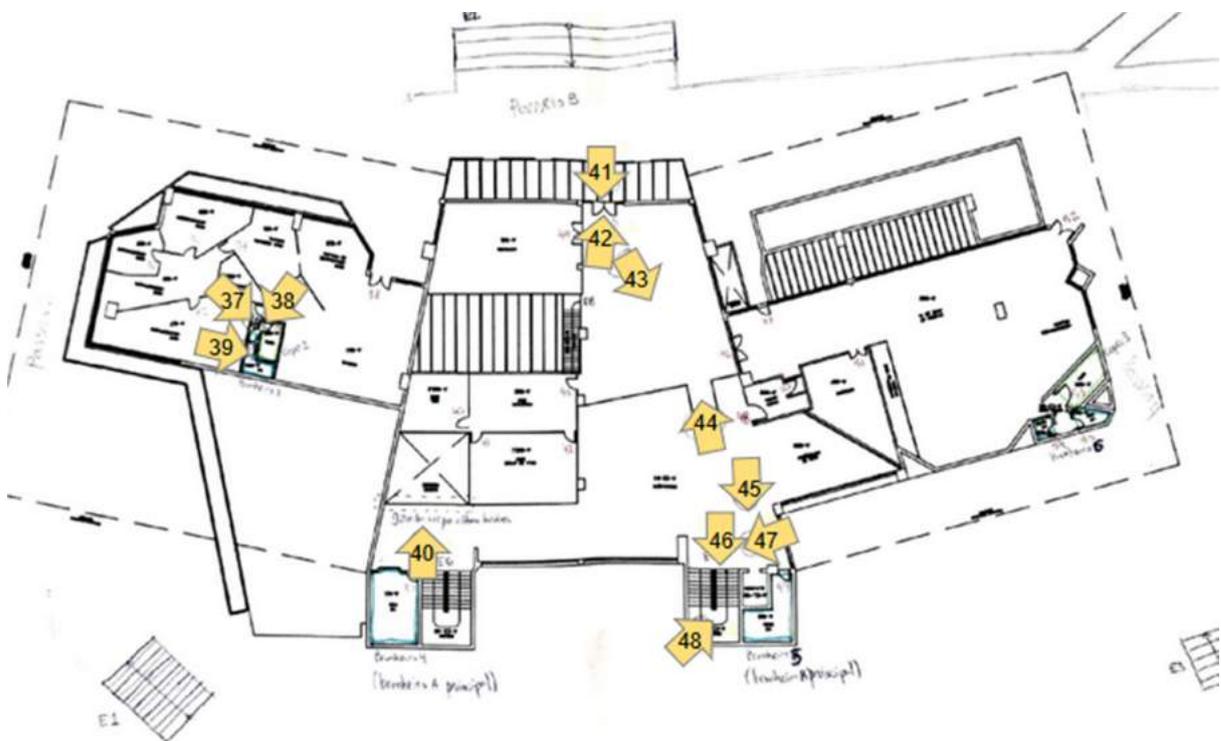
Planta da BCCL – pavimento térreo – Montagem Autor: Dutra, P. 2020
